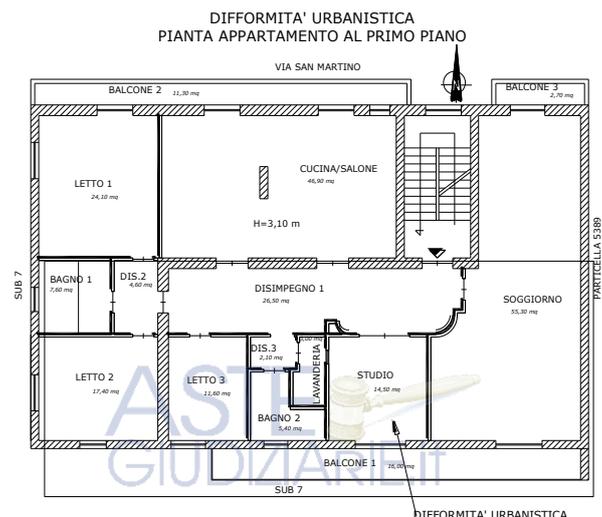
planimetria delle difformità urbanistiche dell'appartamento al primo piano rispetto alla L.E. n.4545/1977 del 21/04/1977
